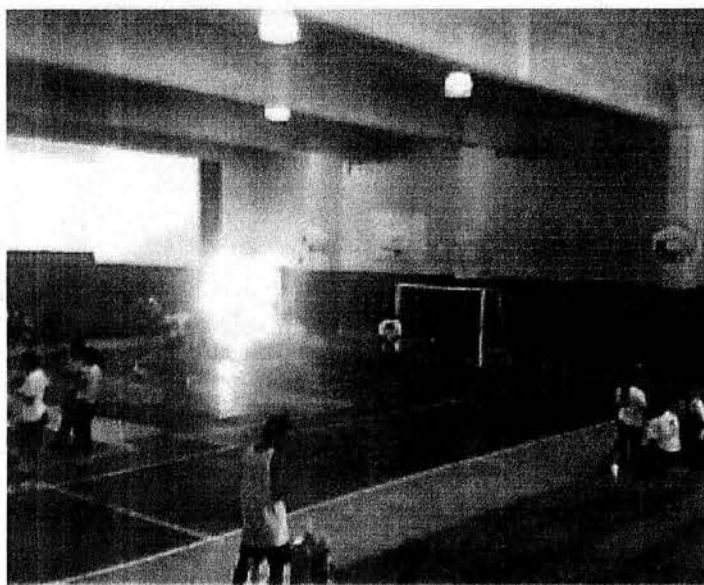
Vista desde el interior del gimnasio, donde se puede apreciar su sistema constructivo que es a base de elementos estructurales de concreto como son: columnas, travesaños y losa .
